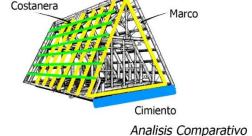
Análisis Estructural Erick Bernabé Barrondo. Fuente: Elaboración Propia
